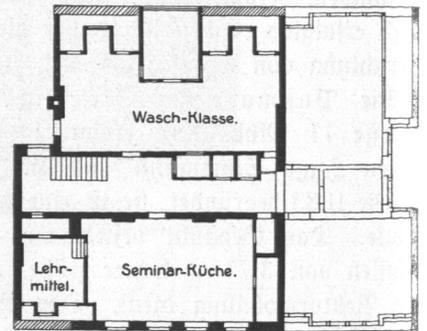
Haushaltungsschule Wallstraße, Dachgeschoss.
